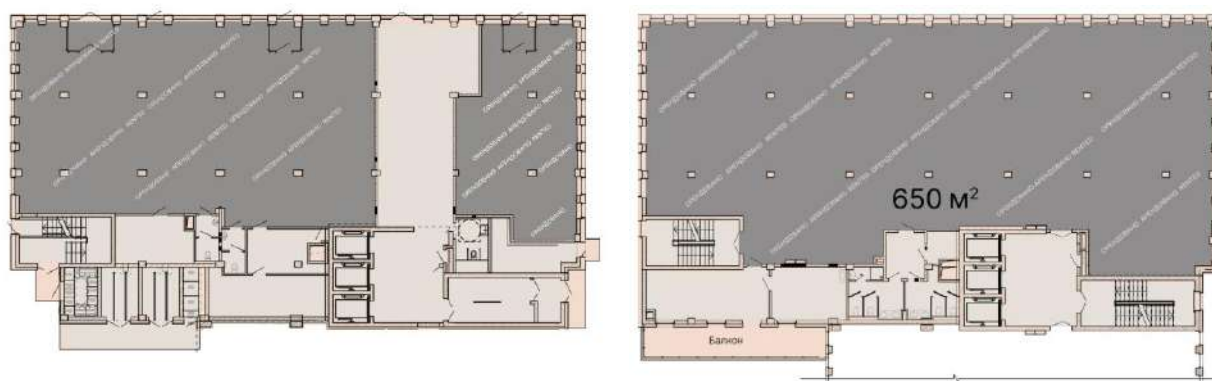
а) – план 1-го поверху; б) – план 2-6-го поверху. [49]
